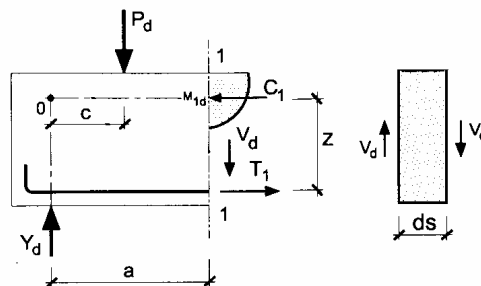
Fuerzas externas e internas en la sección sin fisurar (Proyecto y Cálculo de Estructuras de Hormigón / Calavera)
